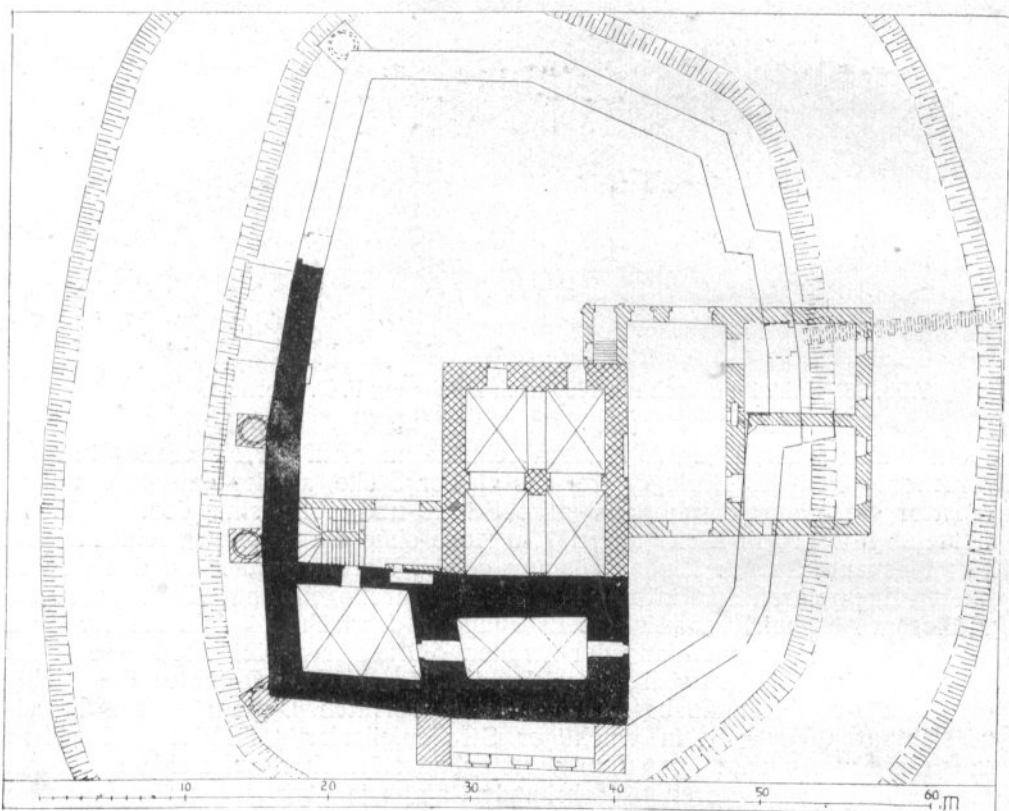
Grundrißskizze der Burg Militsch im Erdgeschoß.
